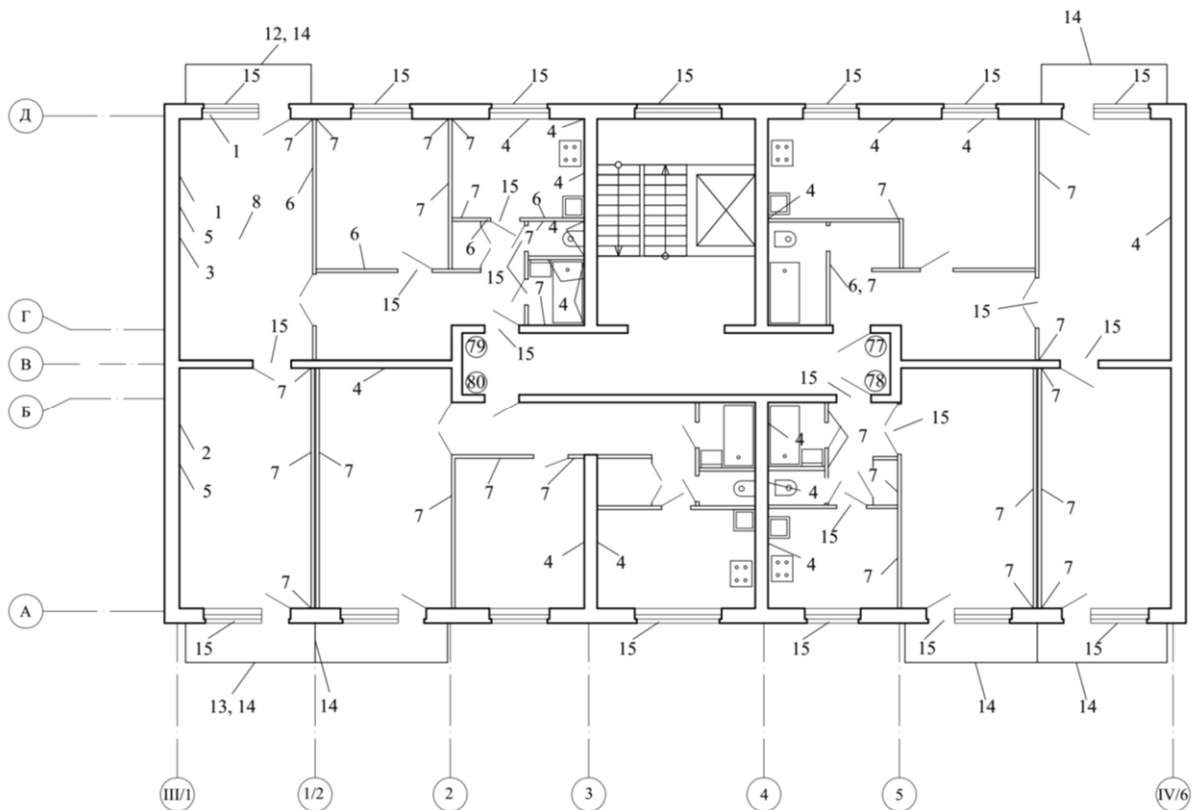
План другого поверху блок-секції № 3 будівлі
